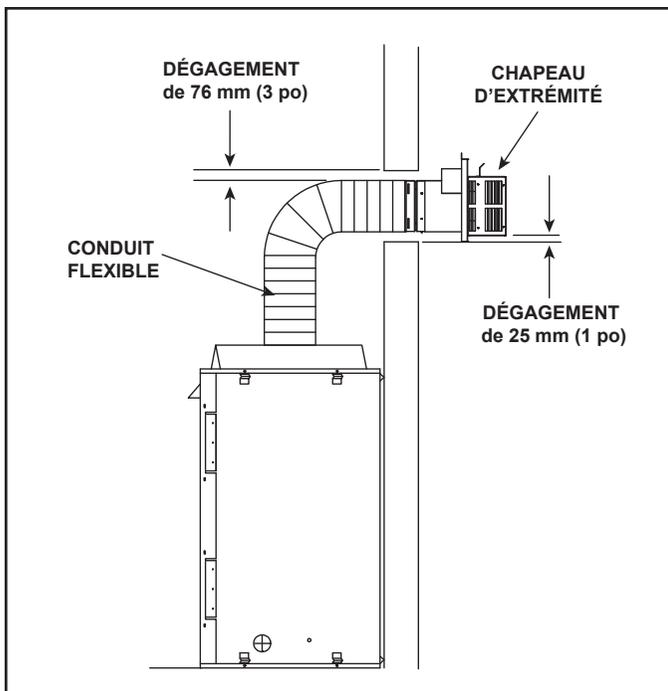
Conduit d'évacuation flexible – Foyer générique illustré
